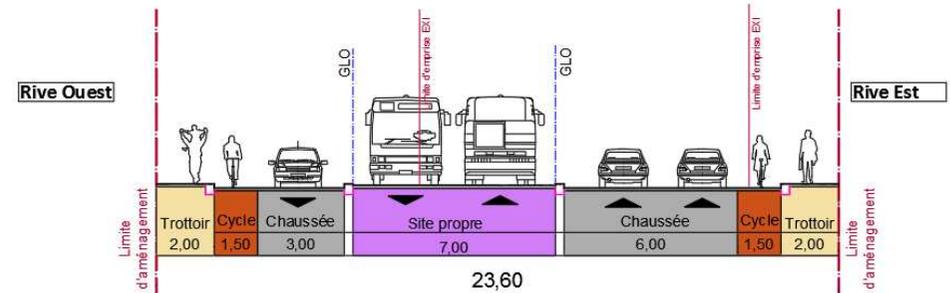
Coupe type en section courante boulevard du Général Delambre
